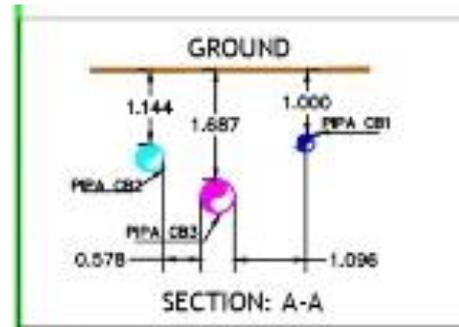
Pendetailan Casing dalam Long Section (Sumber: Dokumen Perusahaan)
